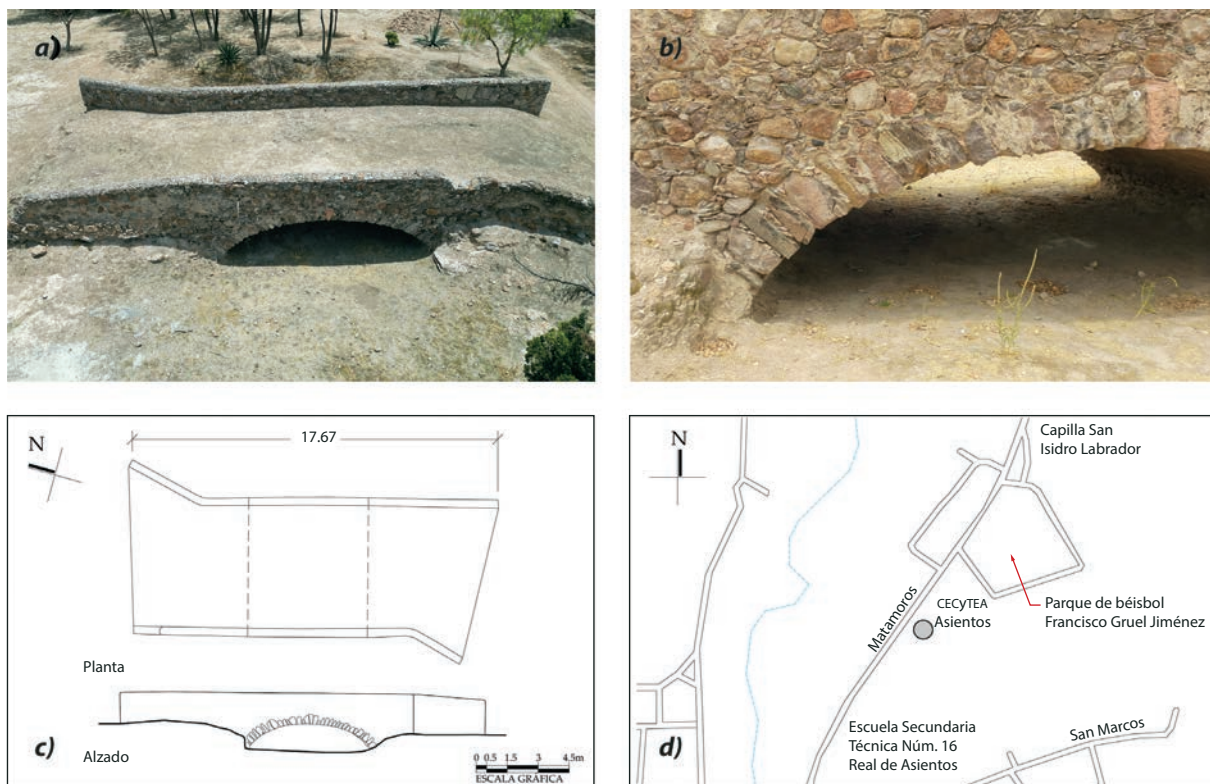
a) alzado oriente, b) detalle de arco y dovelas, c) croquis arquitectónico y d) croquis de localización del puente CECYTEA.
